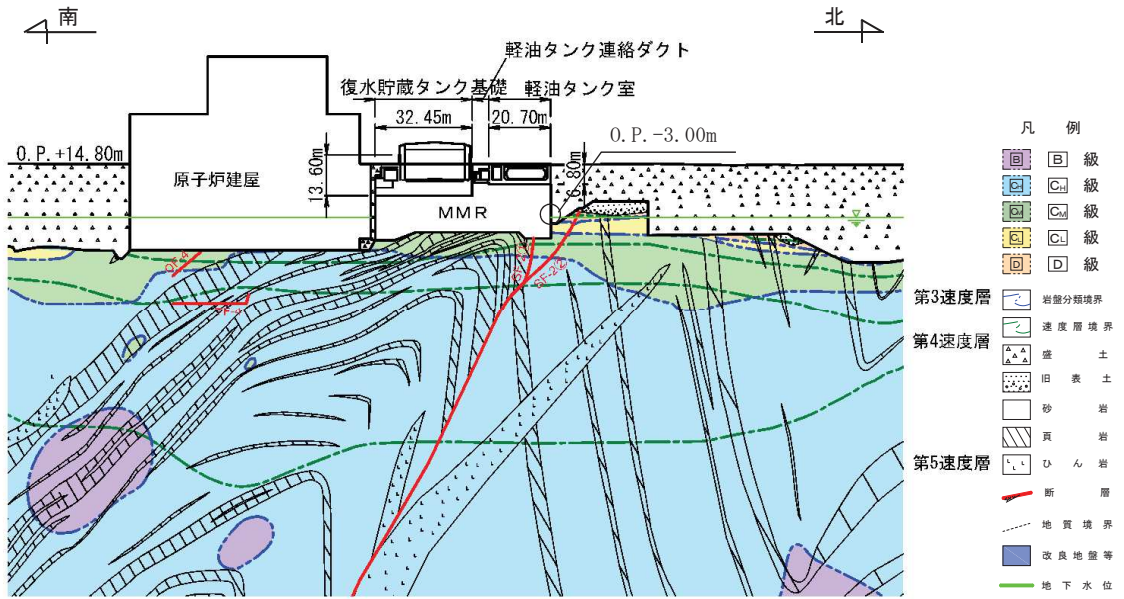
復水貯蔵タンク基礎 地震時荷重算出用地質断面図 (A-A 断面, 南北)
